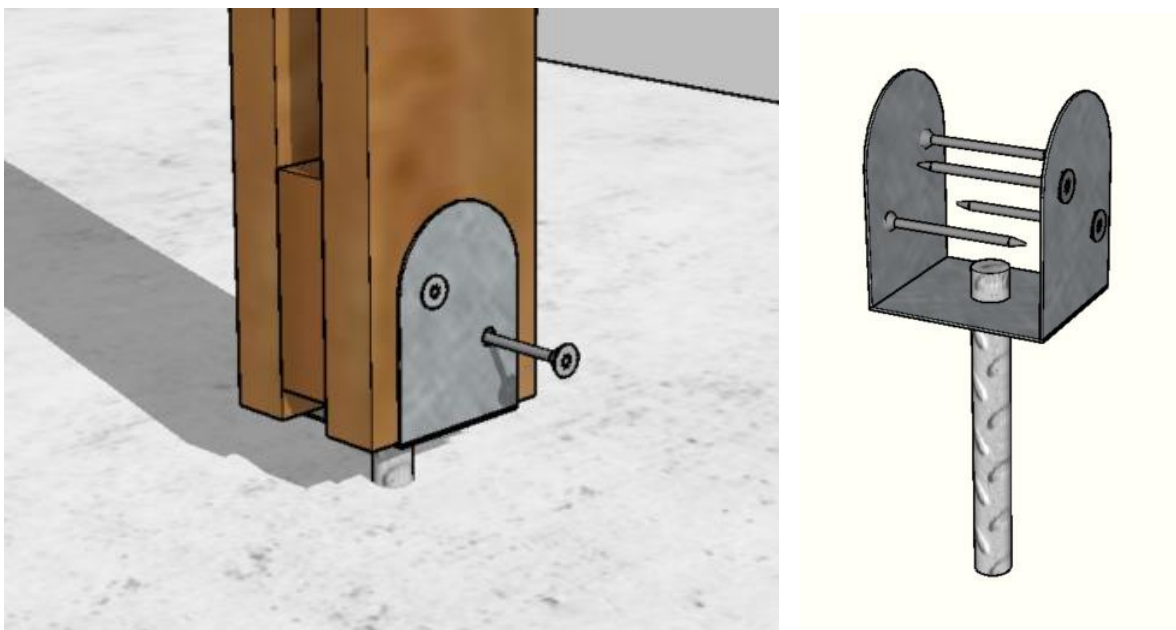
Unión columna – Cimentación (Ver planos estructurales).
